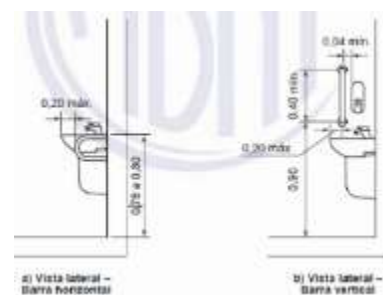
da NBR9050/20 - Barra de apoio no lavatório - Vista lateral
